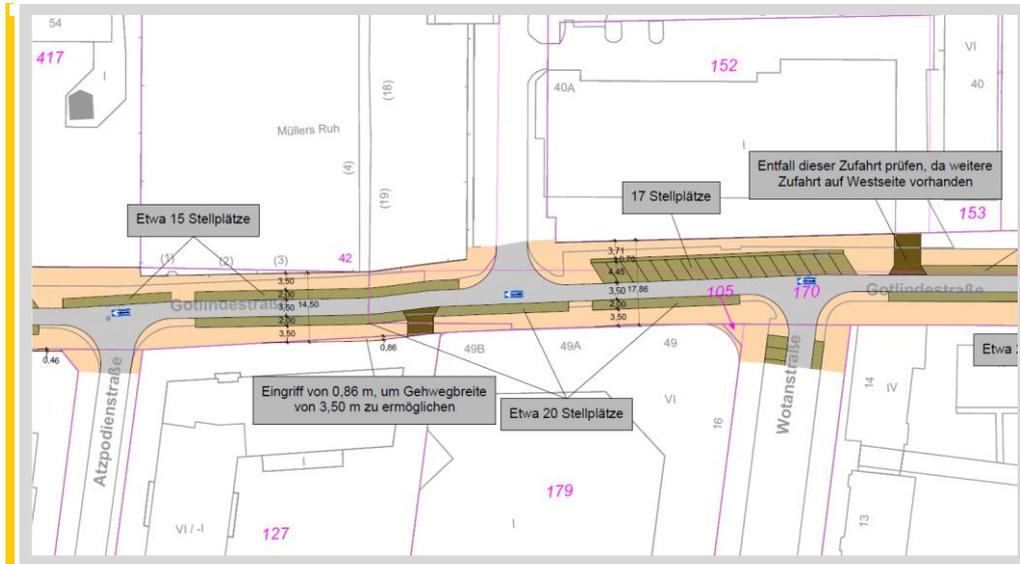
Ausschnitt 2, Lageplan Gotlindestraße (Anhang 7)
